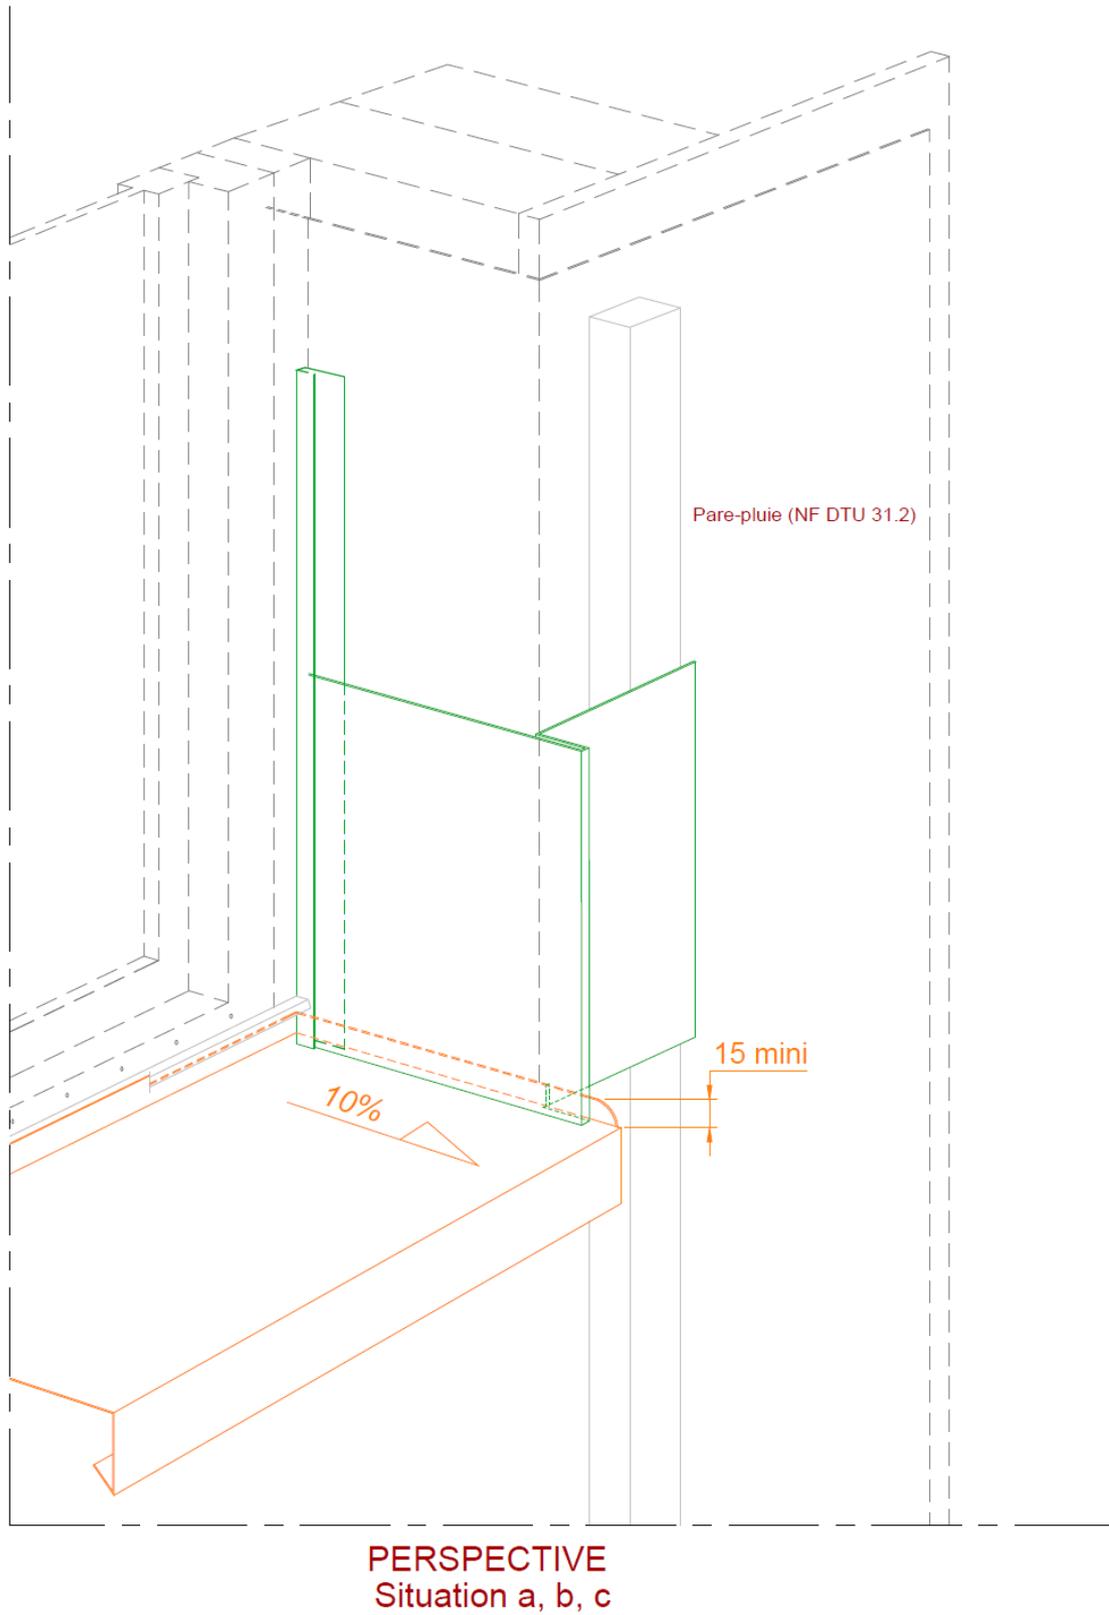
Pose sur COB – Coupe sur appui de baie
